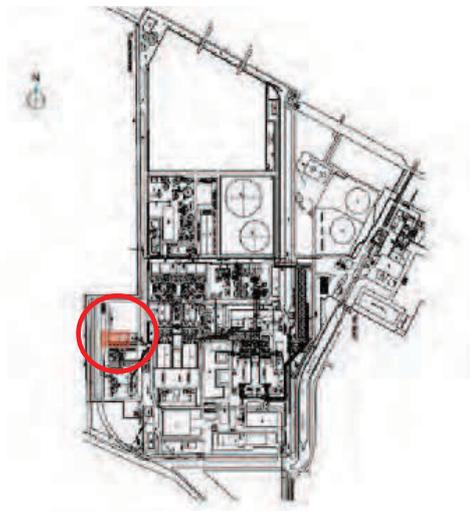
Planimetria della centrale di Fusina - Ubicazione del capannone di stoccaggio del CDR
